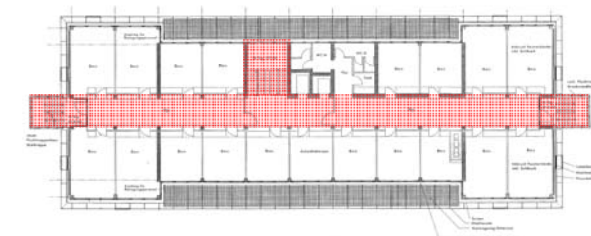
Regelgeschoss Grundriss 2.OG
